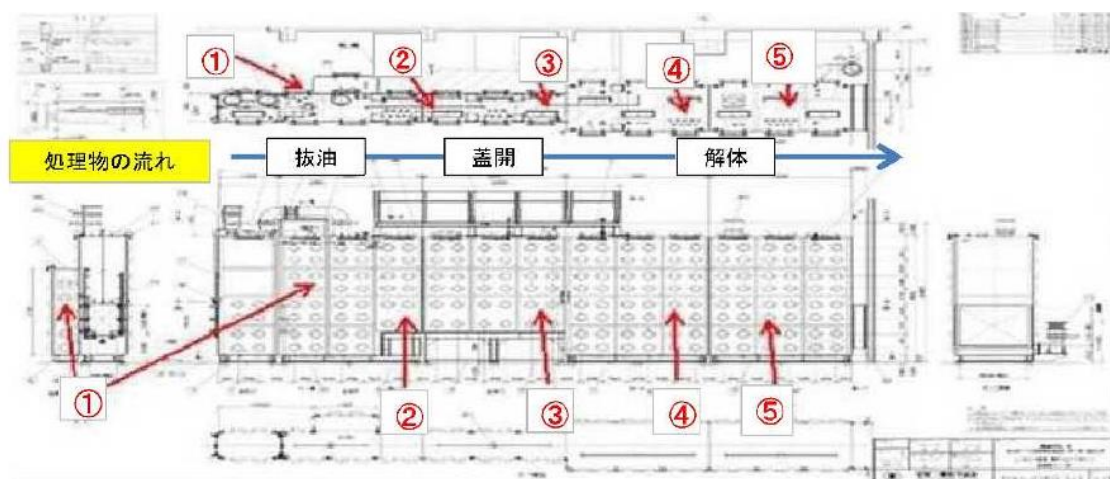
作業環境中 PCB 濃度の測定位置 (GB 内)
